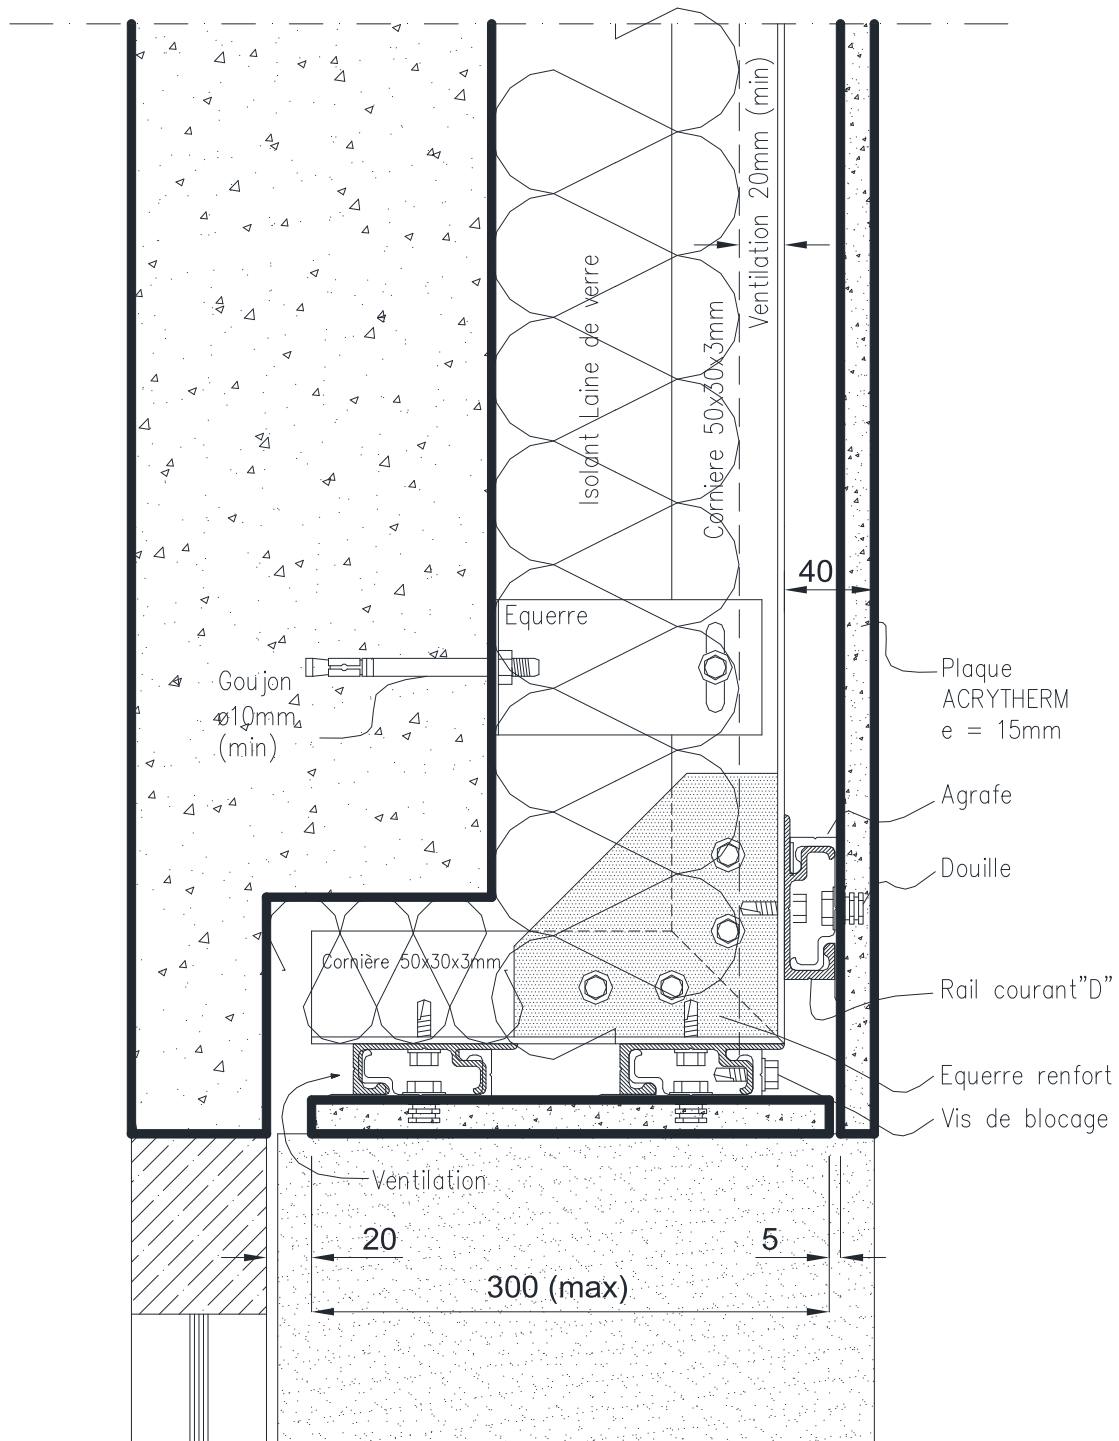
is – Coupe verticale sur linteau – Dalle indépendante
